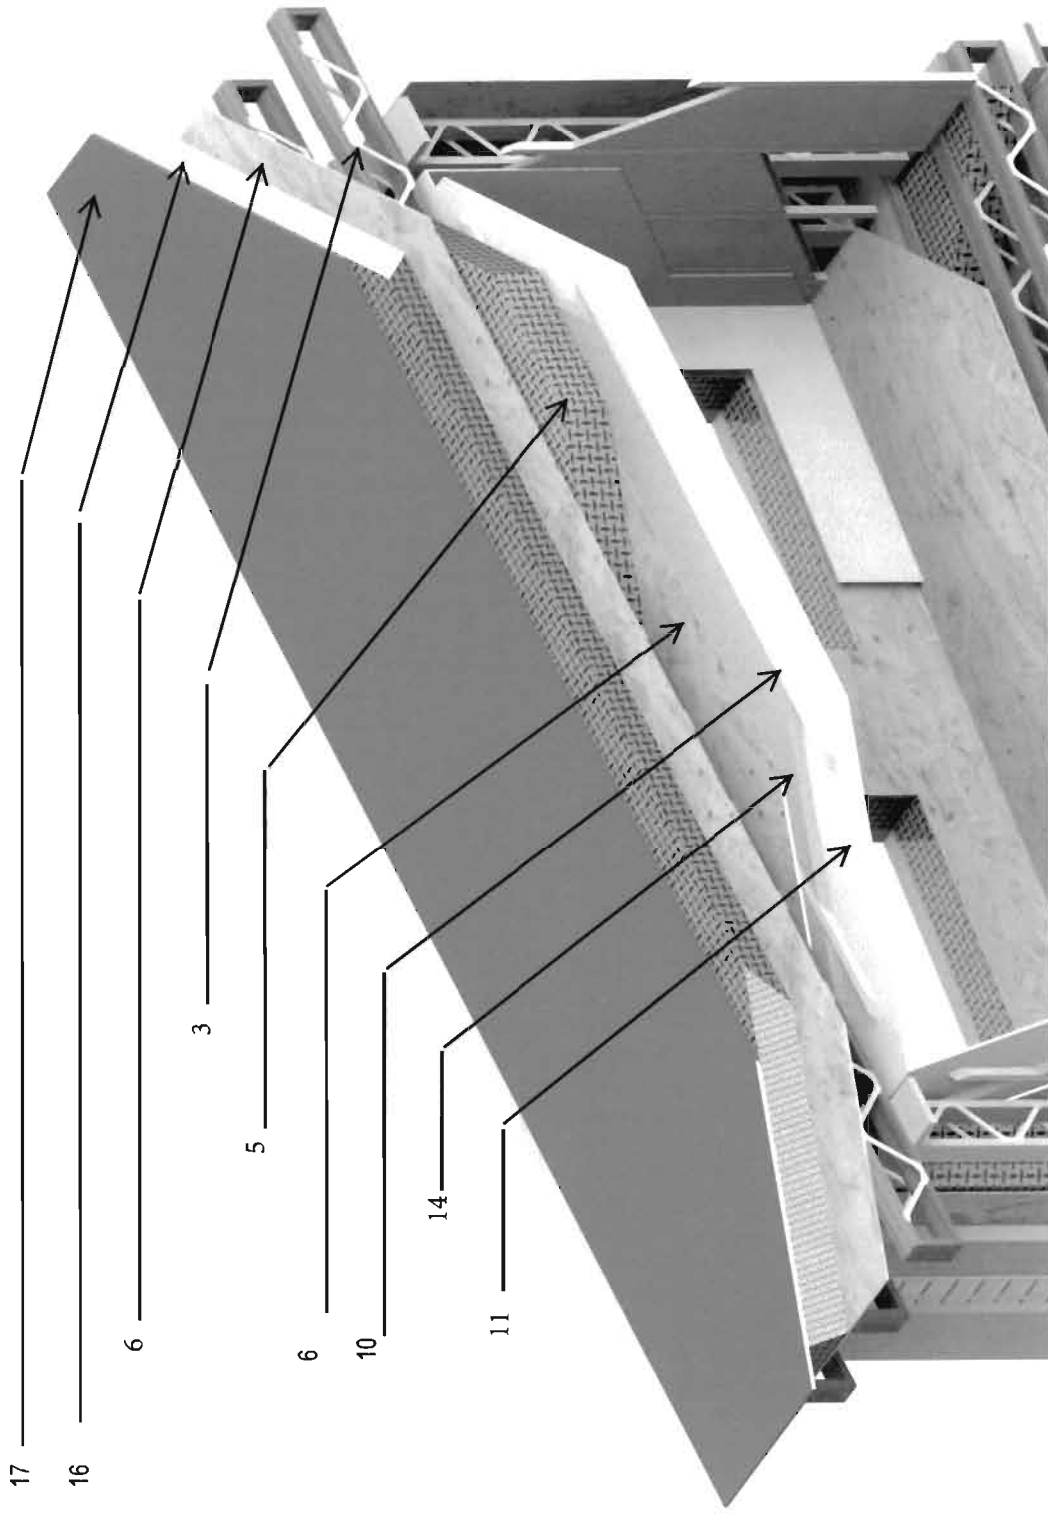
c STRUCTURĂ CAZE® PLANȘEU ETAJ
